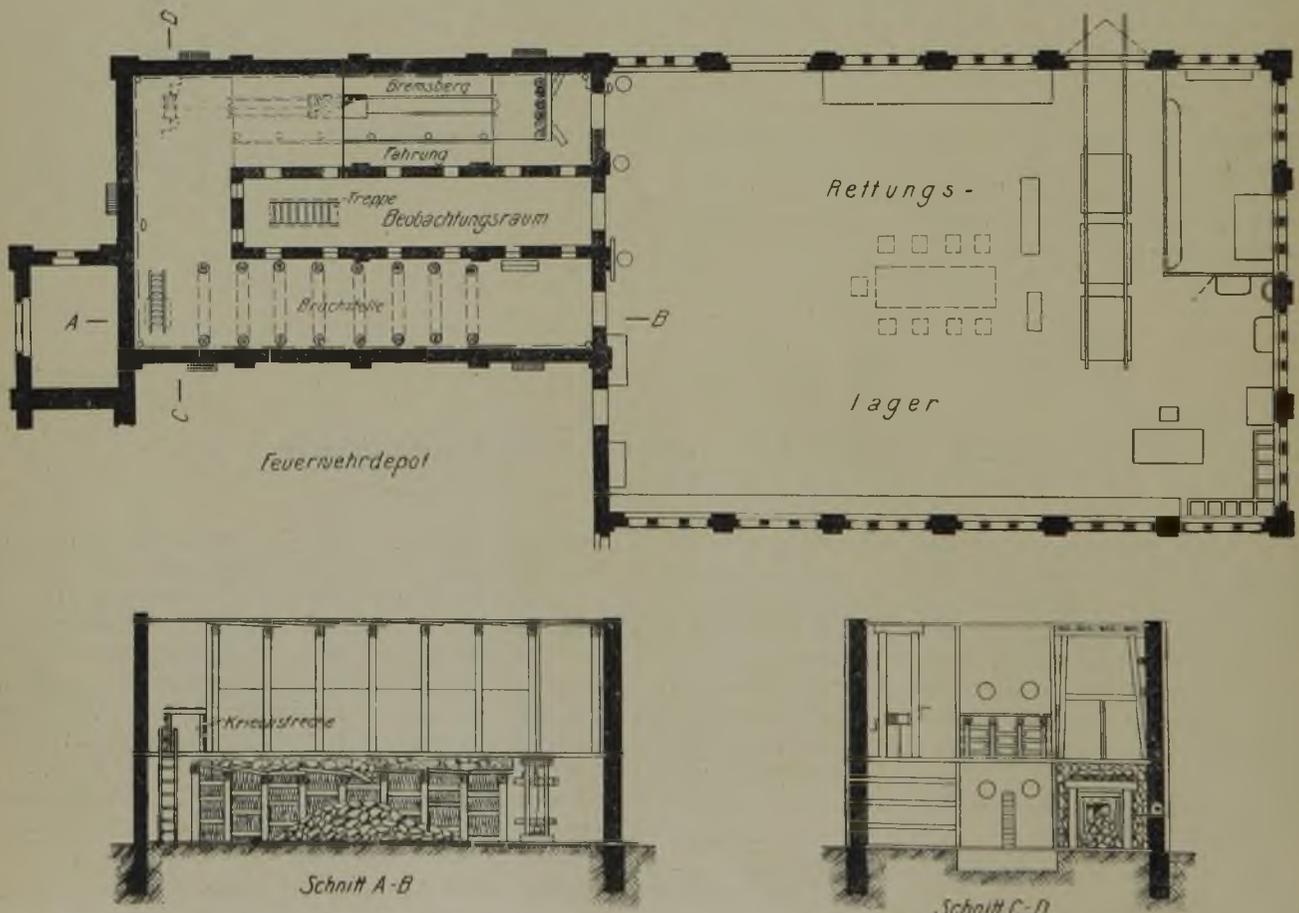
Rettungslager und Übungsraum im Grundriß und in S.hnitten.
